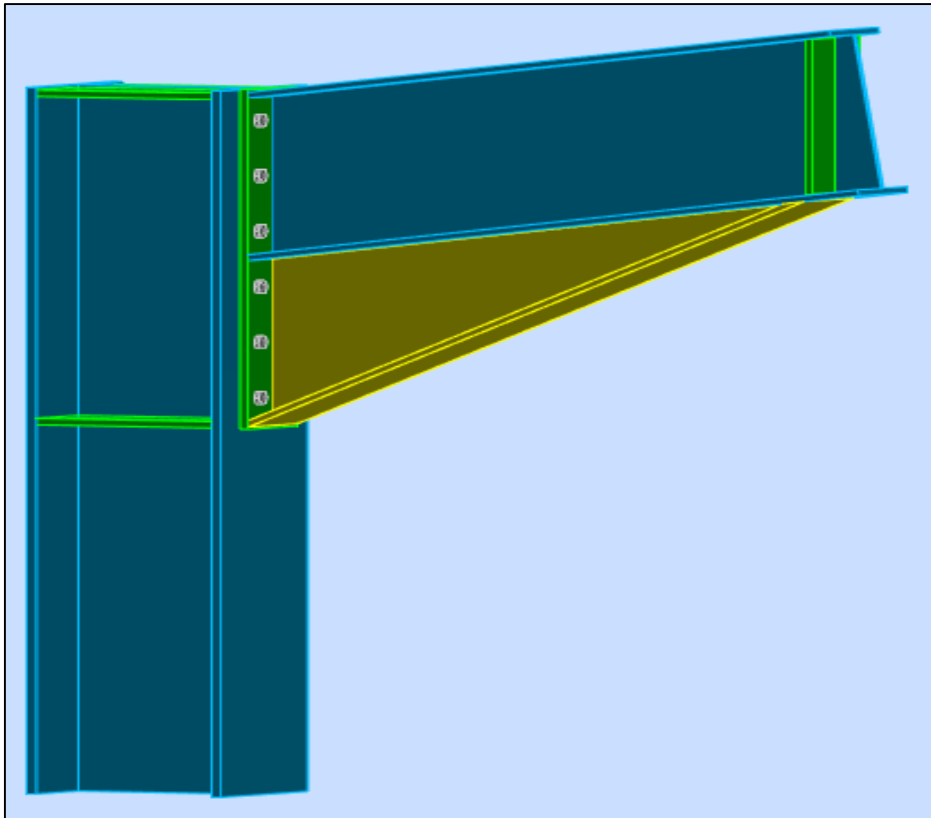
Vue 3D de l'assemblage poteau - traverse.
